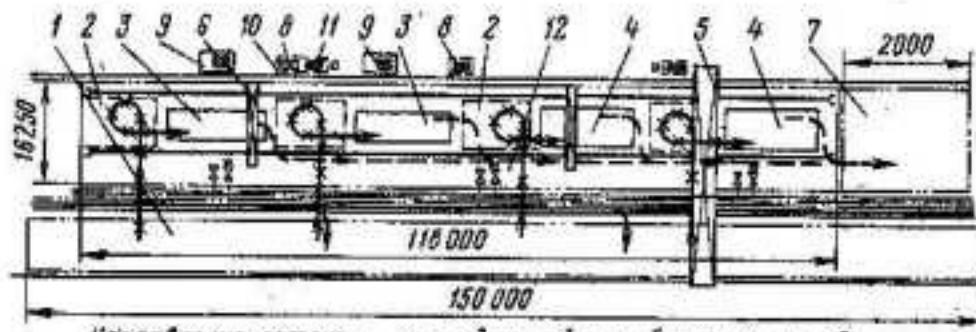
Площадка для сборки блоков трубопроводов.
